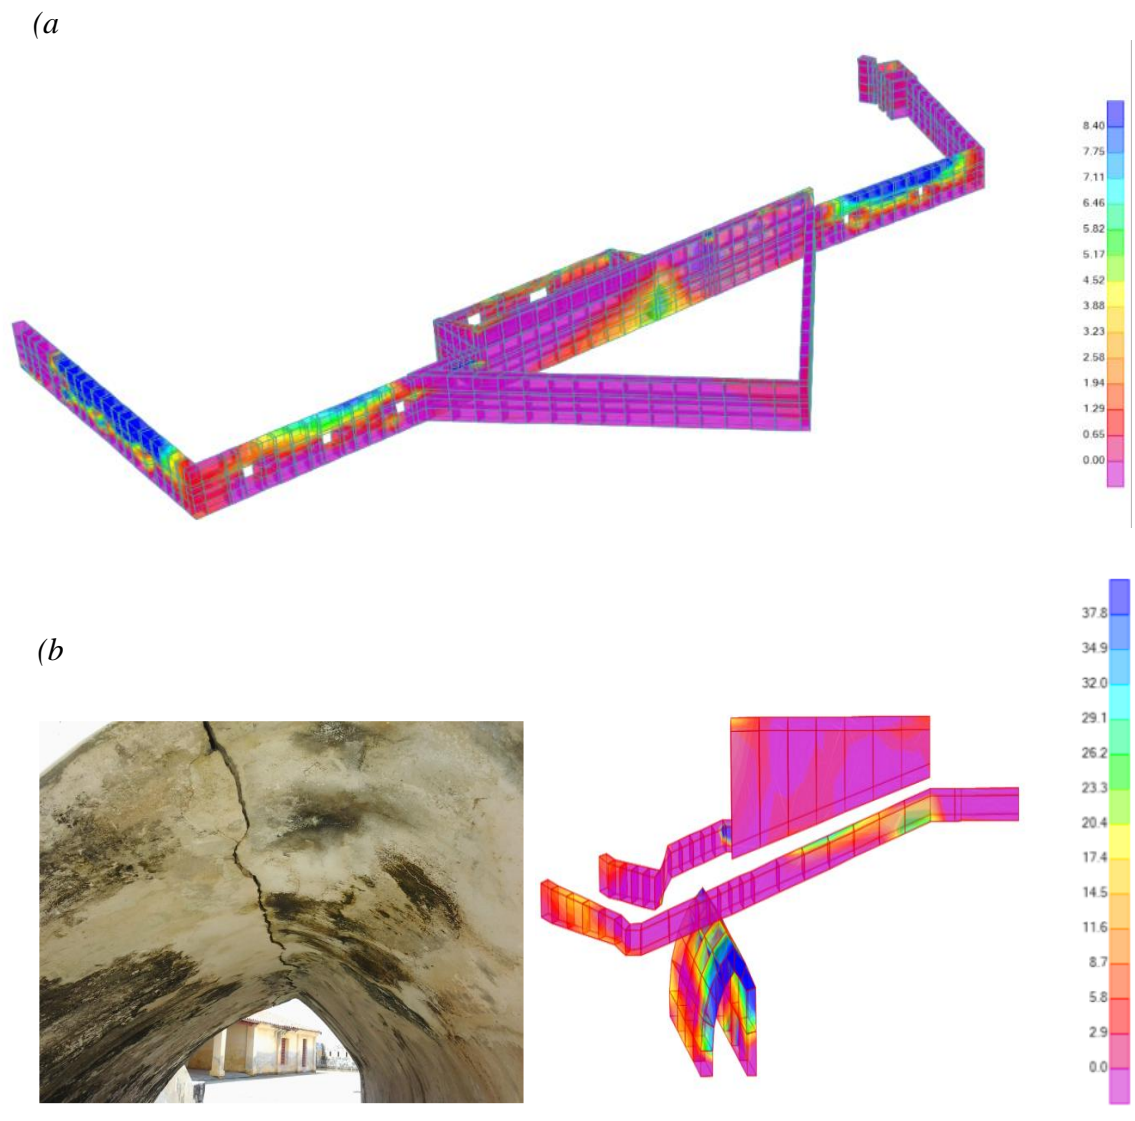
(a) Sobreesfuerzo de tracción S11 presentado en el muro externo (concreto colonial); (b) Sobreesfuerzo de tracción S22 presentado en la rampa (ladrillo), grieta en la clave de la bóveda. Berrocal, A. (2016) [Ilustración]. Recuperado de los Modelos de los Fuertes, SAP 2000 V.16.1.1.
